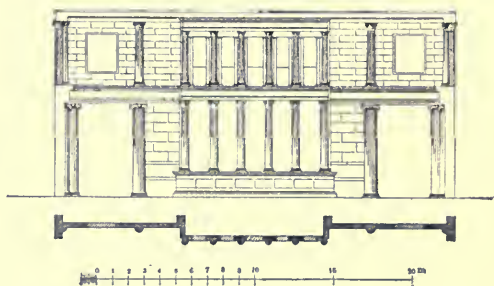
Fassade des Tribunals, Grundriß und Aufriß.
